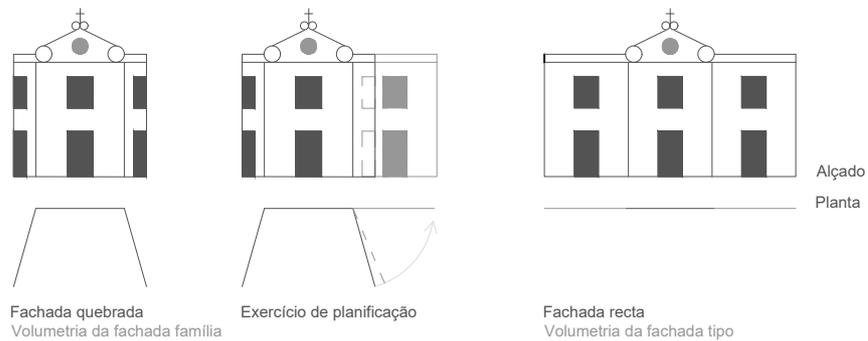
Comparação da volumetria da fachada modelo com a fachada família
